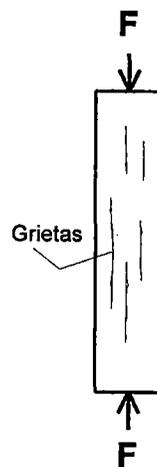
Grietas por compresión excesiva del concreto
